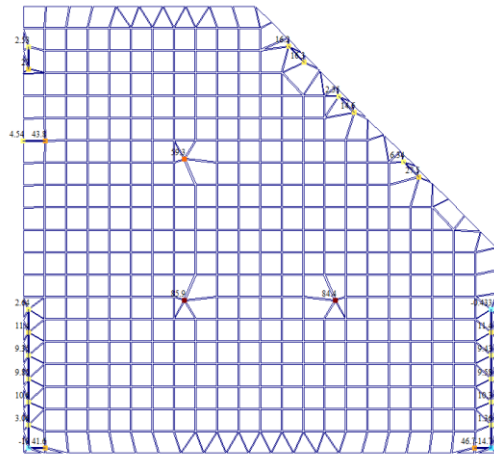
Навантаження на обріз фундаментів від каркасу
